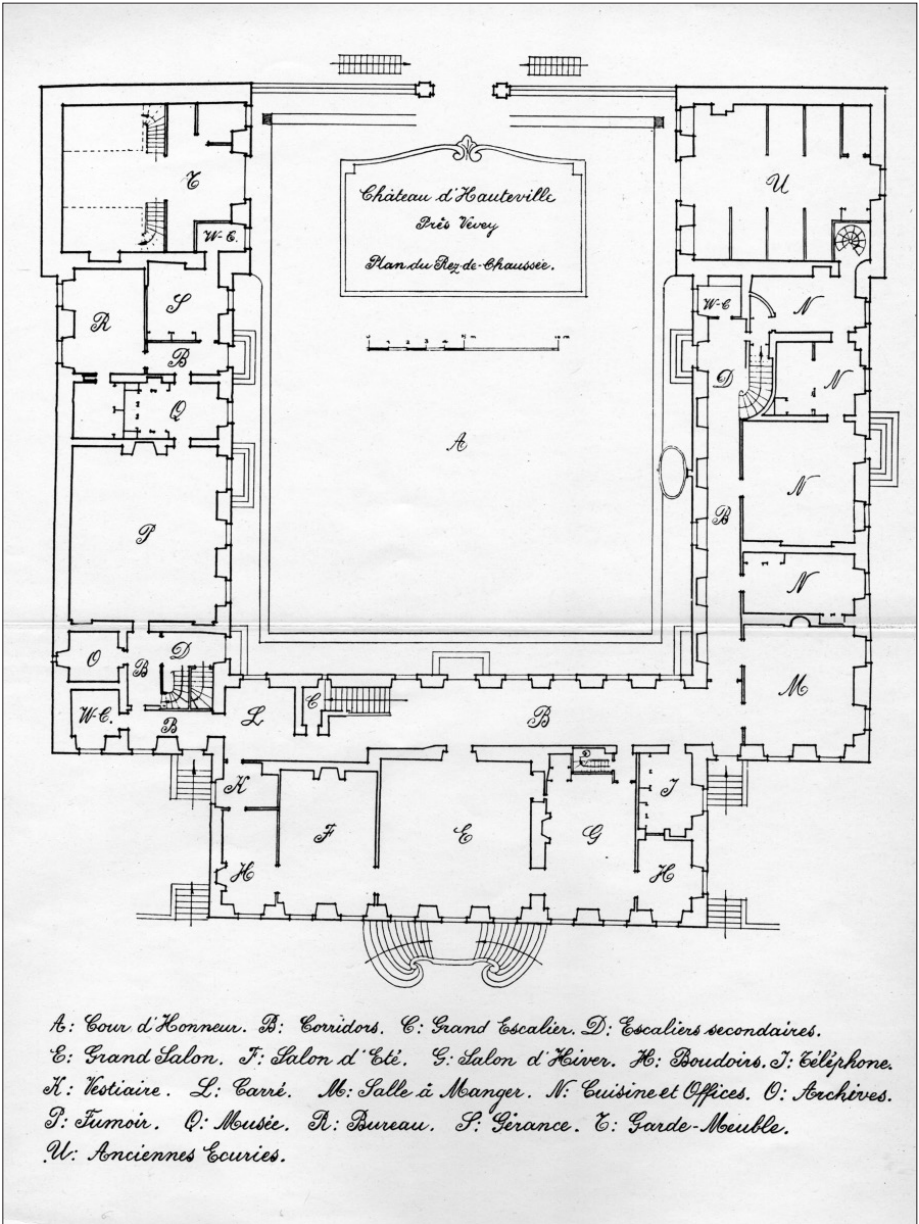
Plan du rez-de-chaussée, tiré de : Le château d'Hauteville et la baronnie de Saint-Légier et La Chiésaz, Lausanne 1932.
